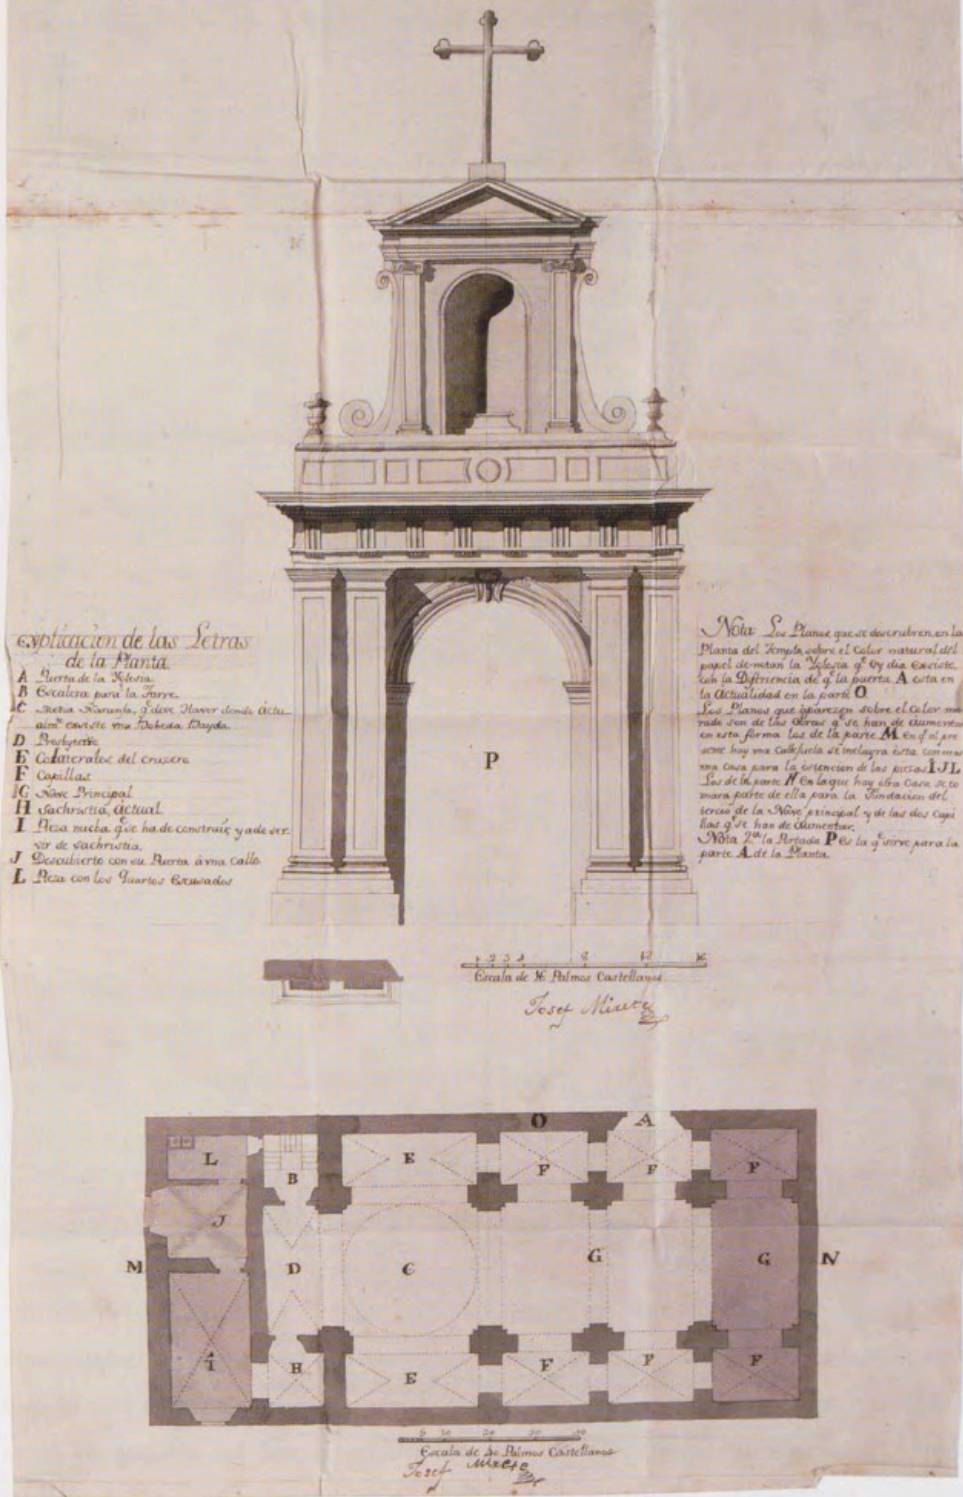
Josef Mirete, Alzado de la nueva puerta del templo y planta propuesta para la ampliación de la iglesia parroquial de Villanueva del Río Segura, 1785, AGP, plano 8702, Madrid, Patrimonio Nacional.
